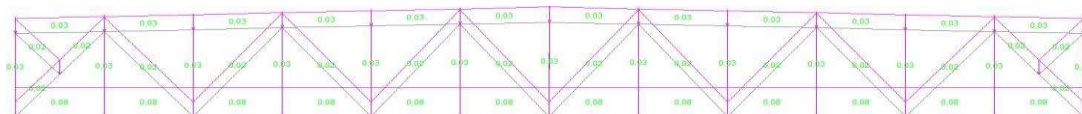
Действие нагрузки от собственного веса фермы
